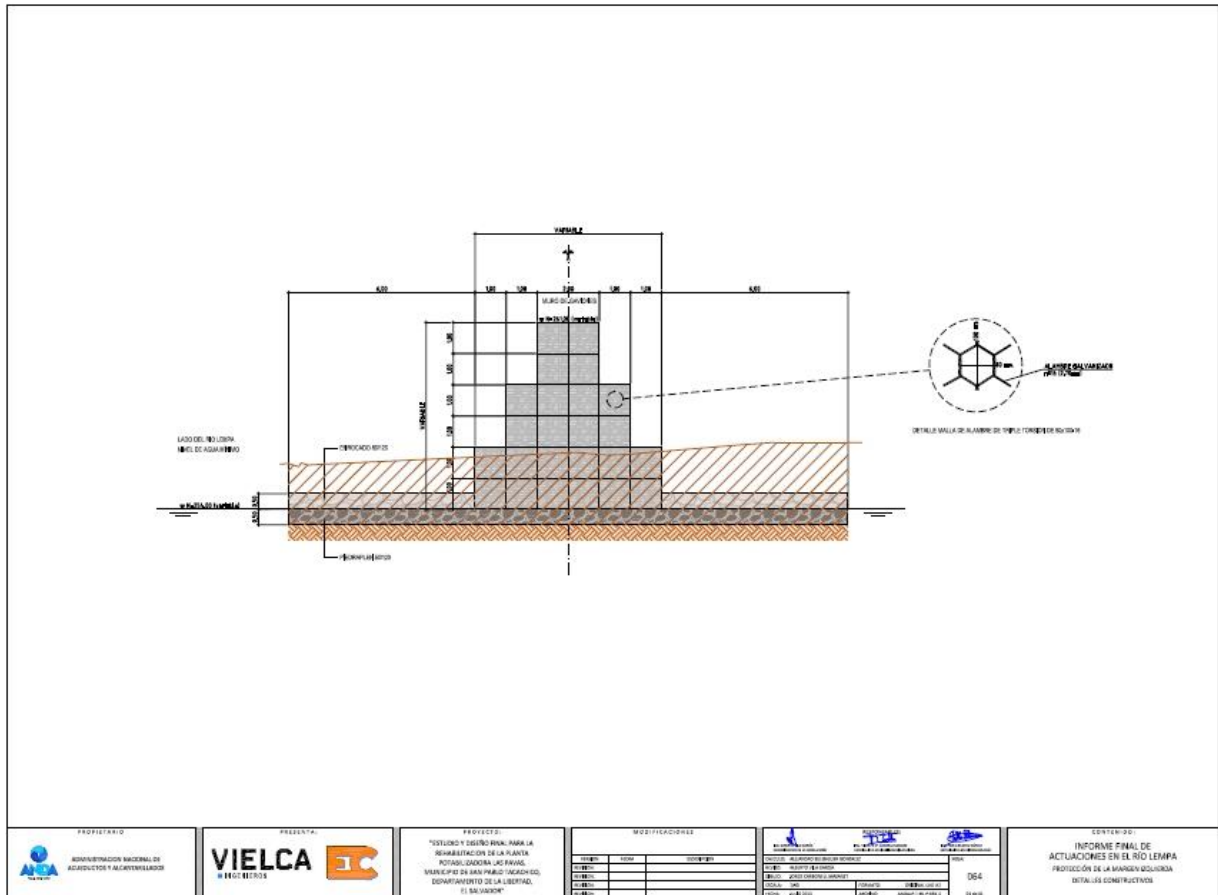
Detalle del Muro de Protección de la Margen Izquierda (extracto del plano ANDALP-T-RL-P-064-1 Protección de la margen izquierda. Detalles Constructivos)
